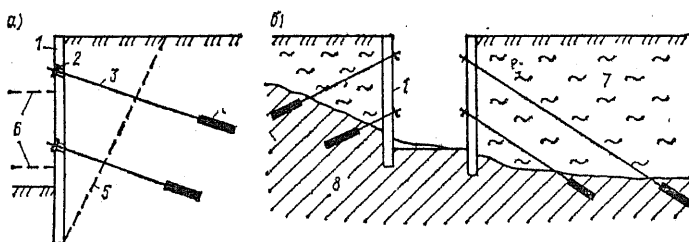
Схемы крепления стен котлованов наклонными анкерами
